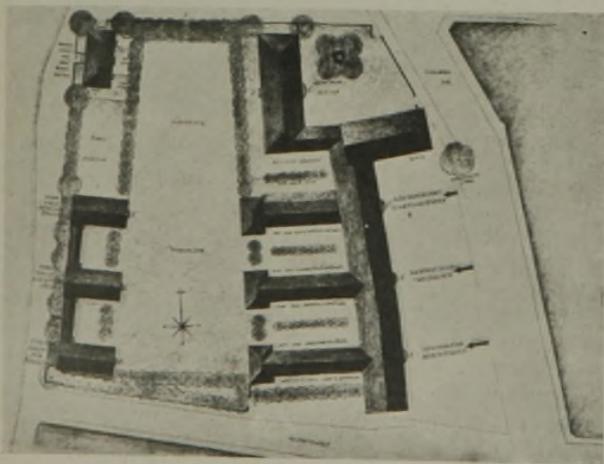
Lageplan mit Aufsicht auf den Bau.
